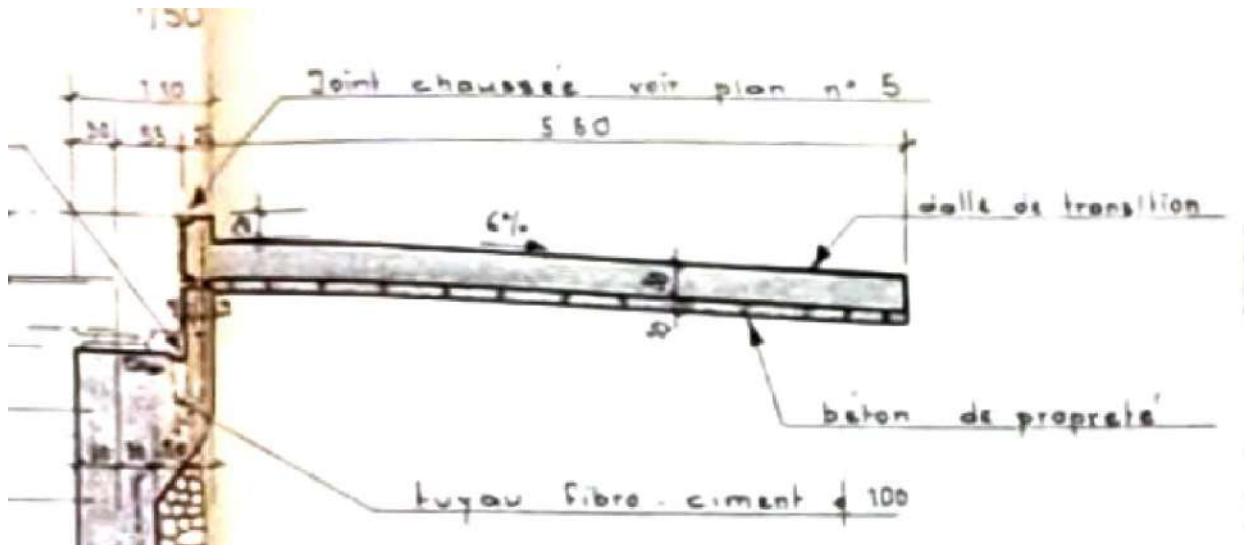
Dalle de transition articulée directement sur une amorce de mur garde-grève
